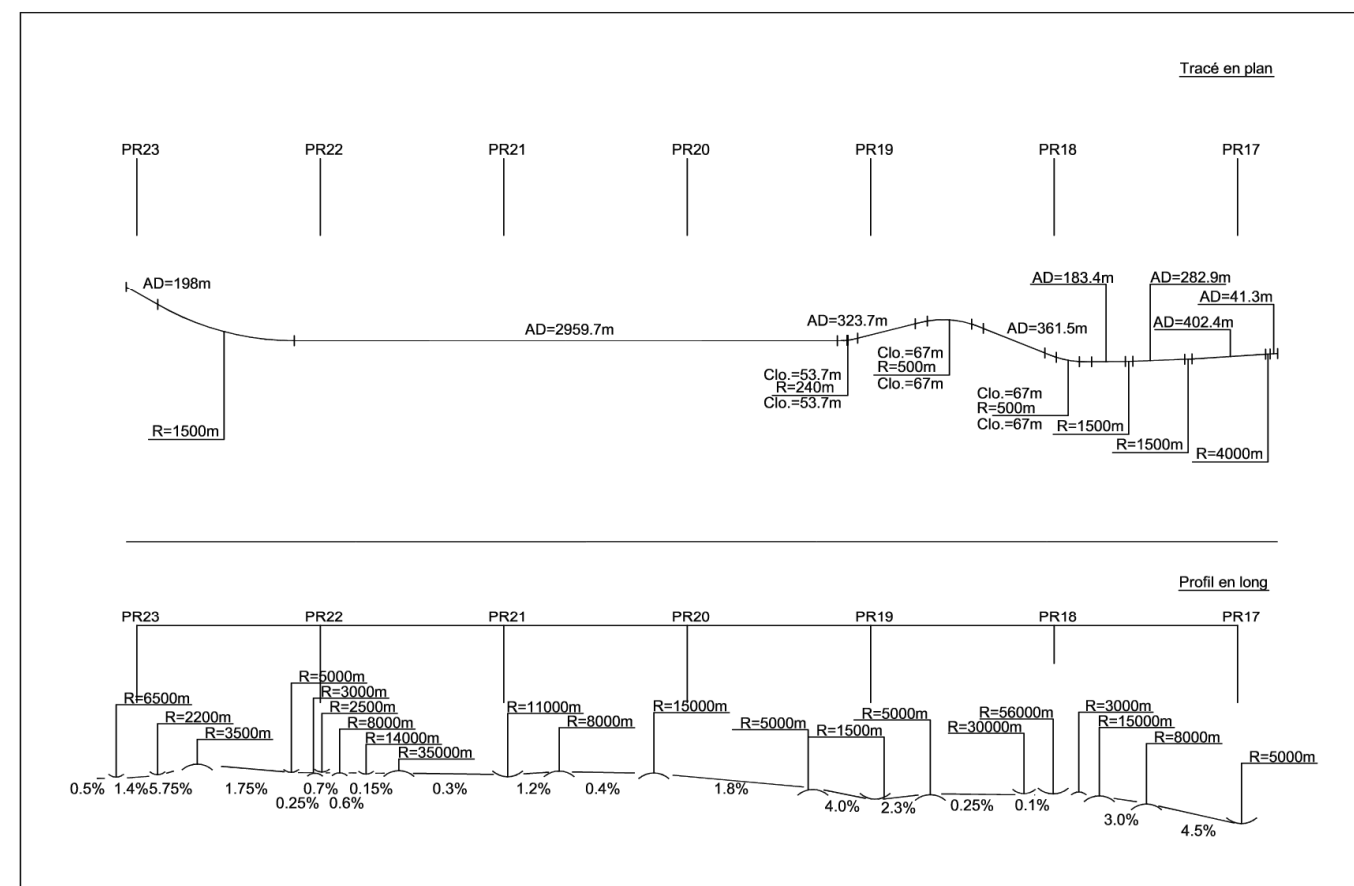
Axe en plan et profil en long de la section (source: SEGIC)
